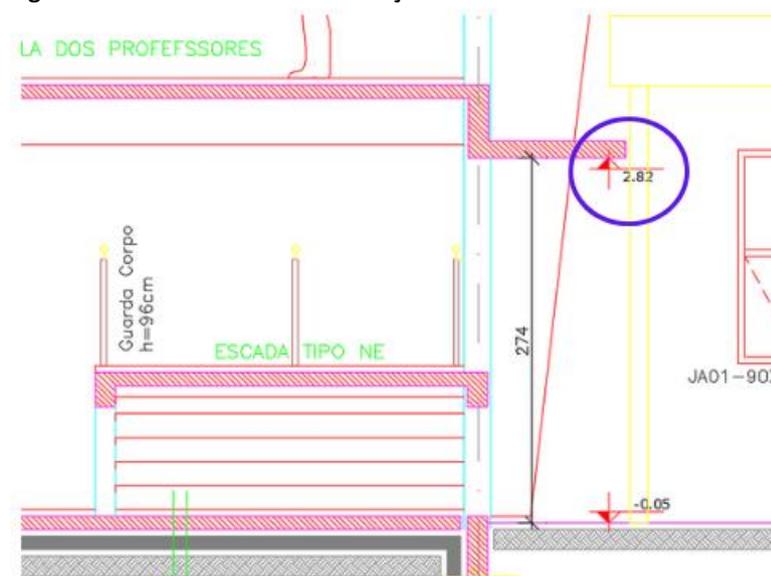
Detalhe de um corte do conflito entre viga e calha com a janela
